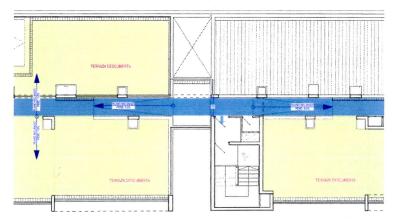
planos inclinados 5,00% con ruta de accesibilidad
